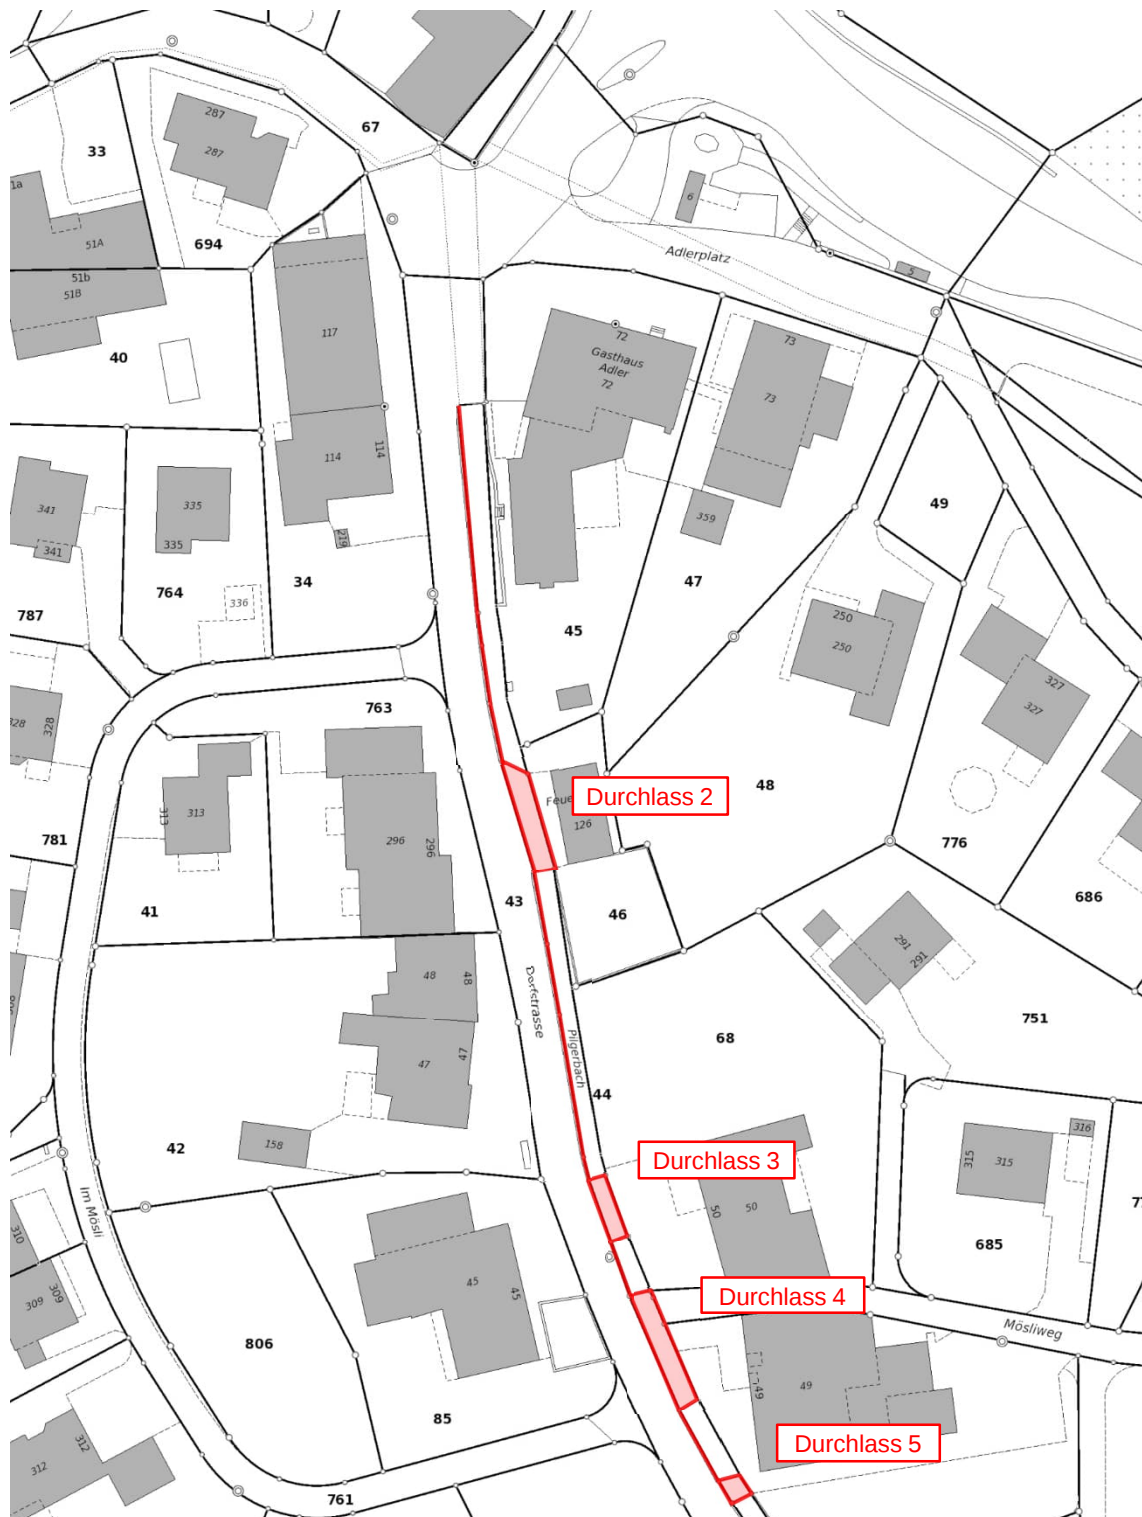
Lageplan mit Objektbezeichnungen (Teil 1/3)
